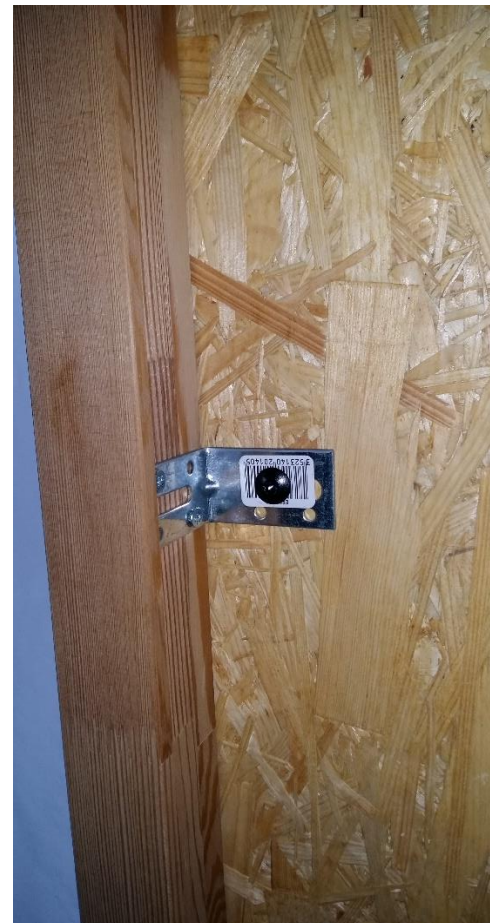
Photos de la fenêtre de la Baie 2' et de son système de fixation (équerre)
